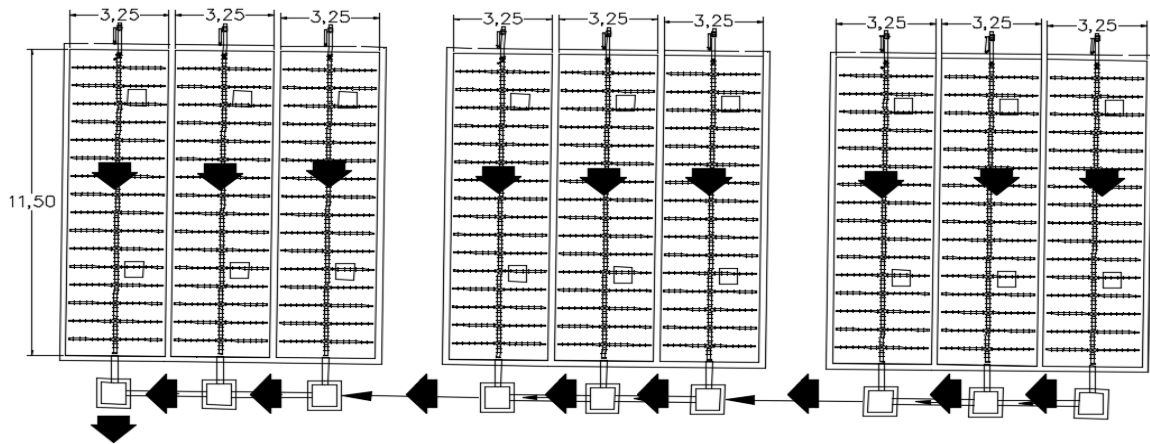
Vista en planta de filtros anaerobios de flujo ascendente planta No. 14.
